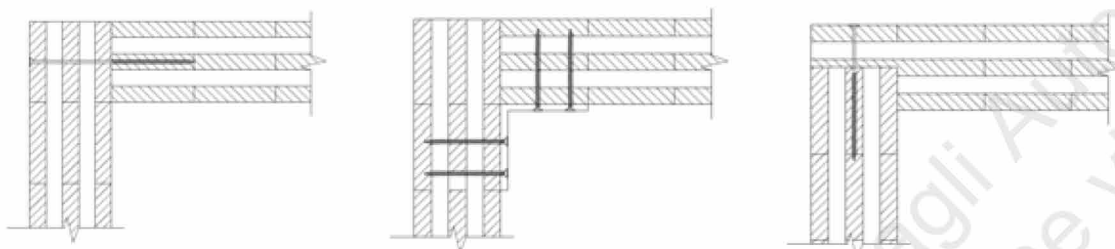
Alcuni particolari costruttivi dei collegamenti parete-parete d'angolo
